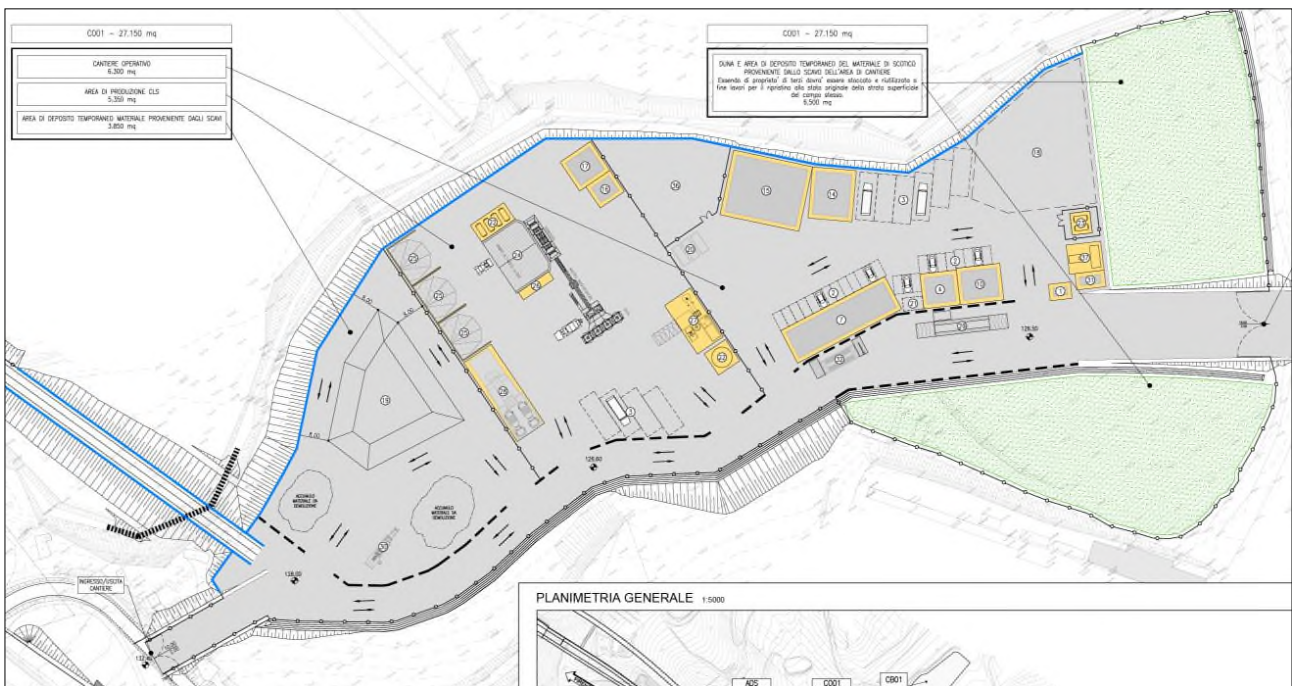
Stralcio planimetrico dell'area di cantiere CO01 nel Lotto 1
